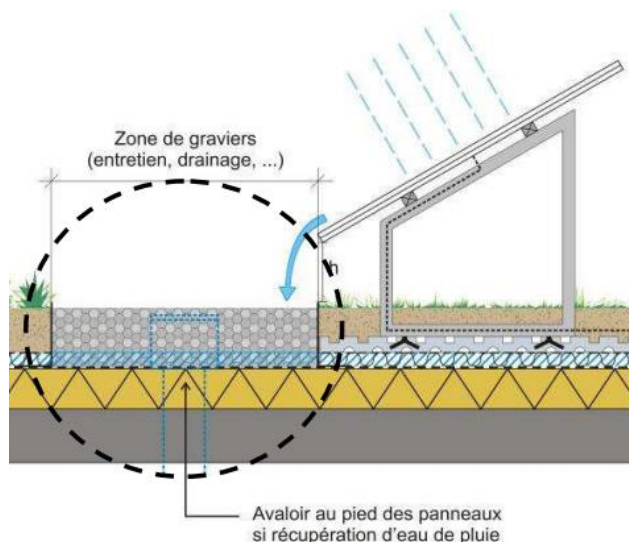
Exemple de détail en pied de panneaux permettant de faciliter la récolte de l'eau de pluie tout en limitant l'impact du ruissellement sur la toiture verte
